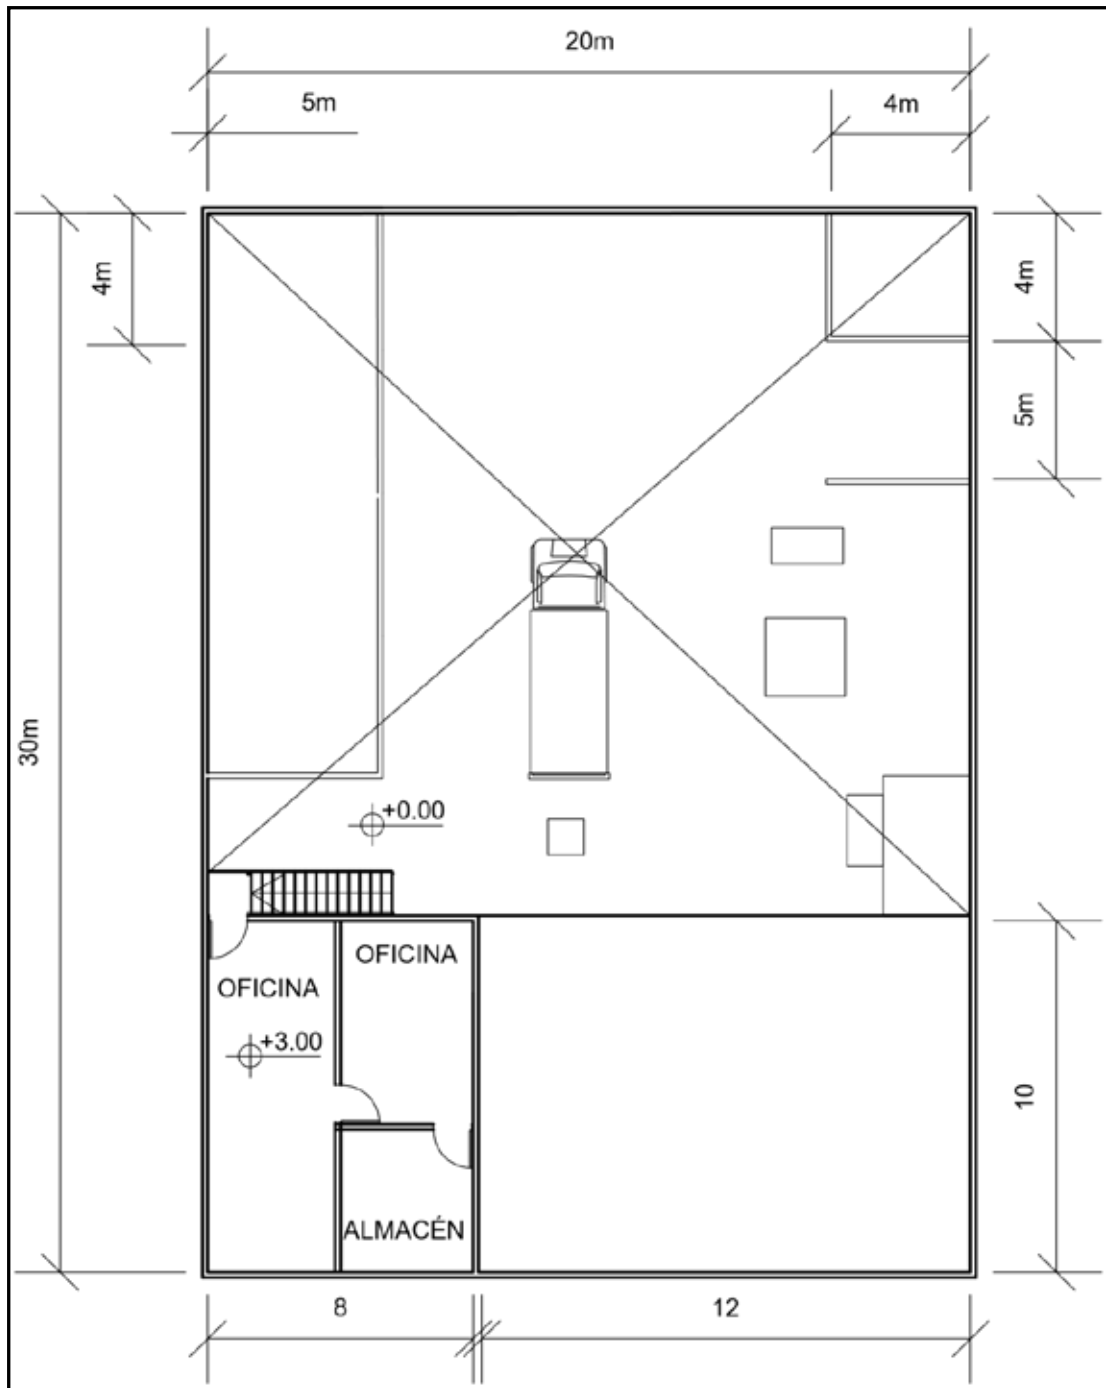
Distribución de planta. Planta de arriba. Fuente: Armas, D. (2018)
